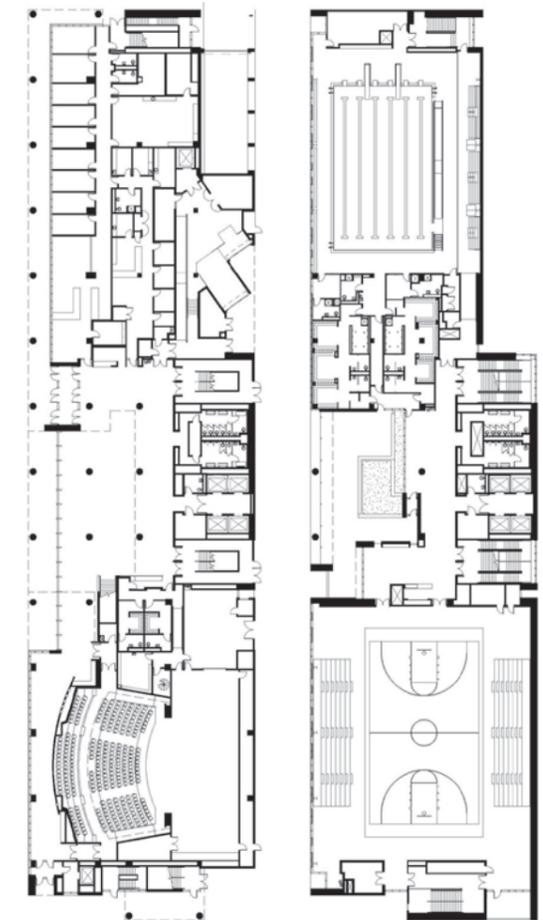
+ Abb.24 + Abb.25 3D-Schnitt, Grundriss Erdgeschoß, Grundriss E7
